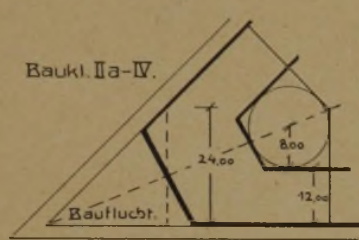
Abstumpfung einer spitzwinkligen Ecke bei $\frac{3}{10}$ zulässiger Bebauung.
